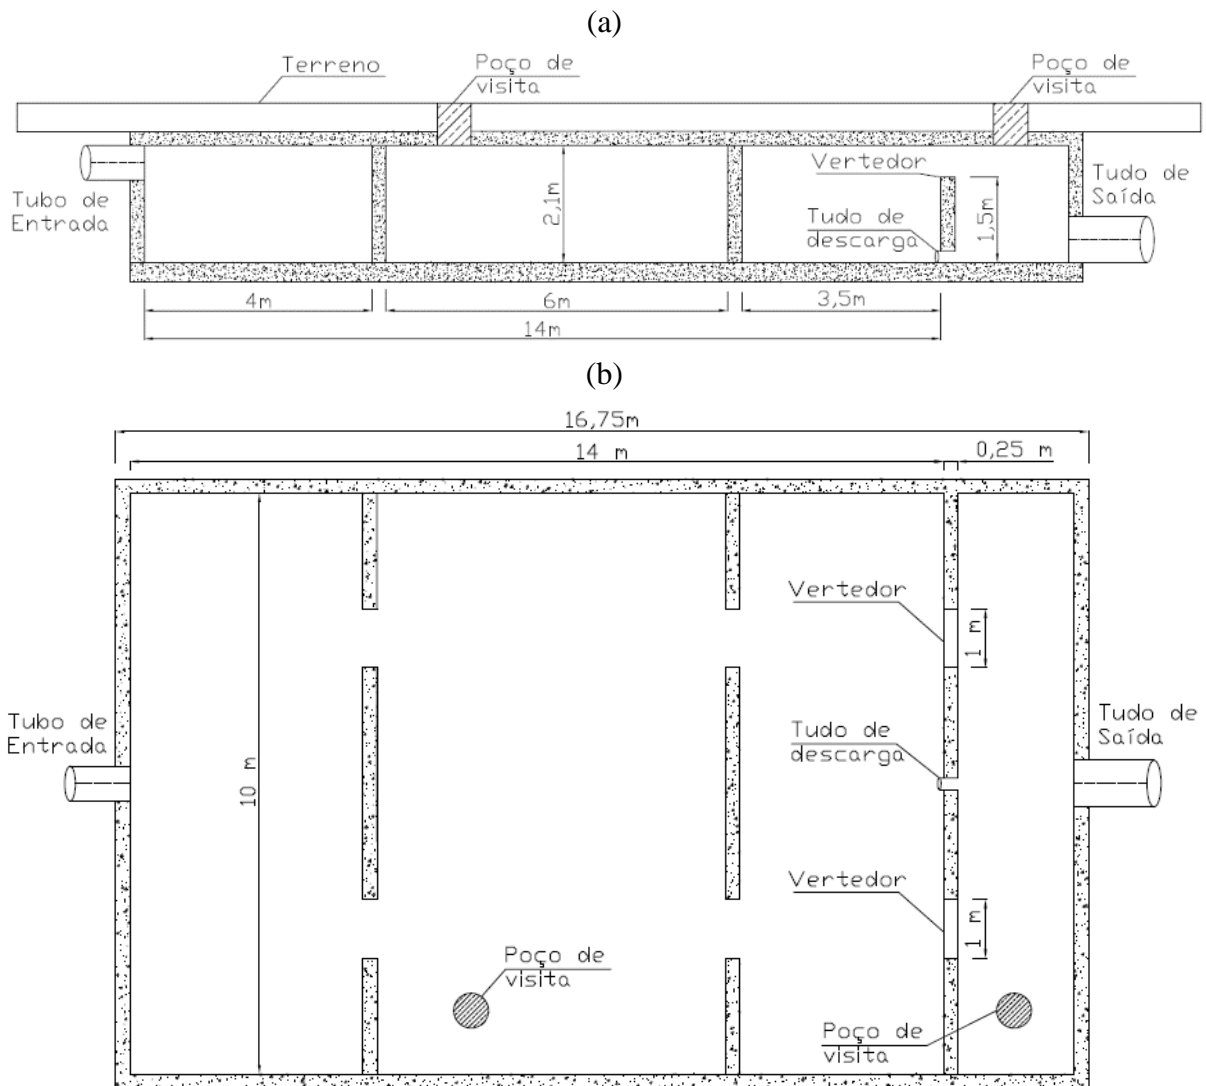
Configuração dos microrreservatórios MV-1 e MV-2 (a) Perfil (b) Planta
